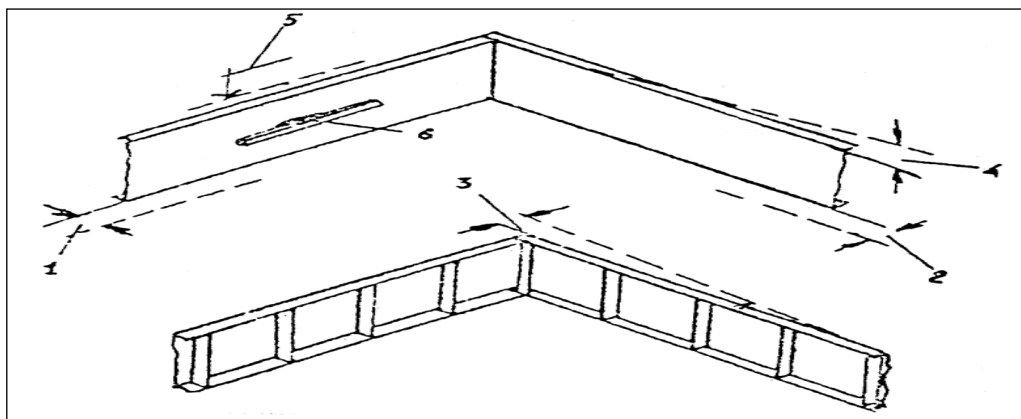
Схема допускаемых отклонений при установке опалубки:
